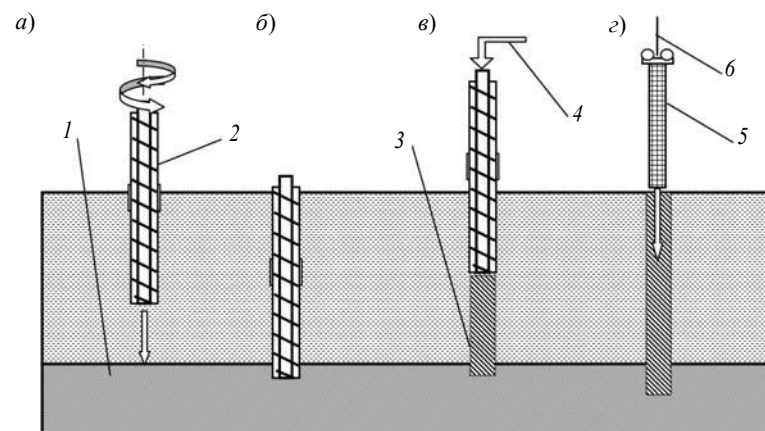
Технологическая последовательность устройства свай: а, б – бурение на проектную отметку; в – извлечение шнека с одновременным заполнением бетоном скважины; г – вибрационная установка арматурного каркаса в бетонный ствол; 1 – несущий слой грунта; 2 – обсадная труба с проходным шнеком; 3 – заполненная бетоном скважина в грунте; 4 – направление подачи бетона в скважины через полость шнека; 5 – арматурный каркас; 6 – вибратор на крюке-кране
